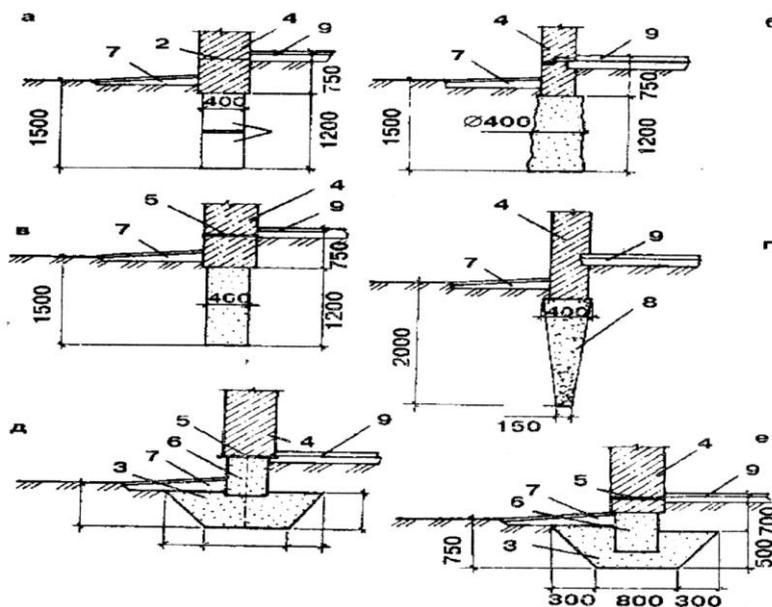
Фундаменты, используемые в домостроении: а - ленточный сборный фундамент; б - буронабивная свая; в - ленточный монолитный бутобетонный фундамент; г - пирамидальная свая; д - незаглубленный фундамент; е – мелкозаглубленный фундамент; 1 - блоки ФБС 24,4; 2 - гидроизоляция - цементный раствор; 3 - песок; 4 - бетонный блок - цоколь; 5 - гидроизоляция (толь); 6 - бетонный блок; 7 - отмостка; 8 - пирамидальный бетонный блок; 9 - бетонная подошва пола
